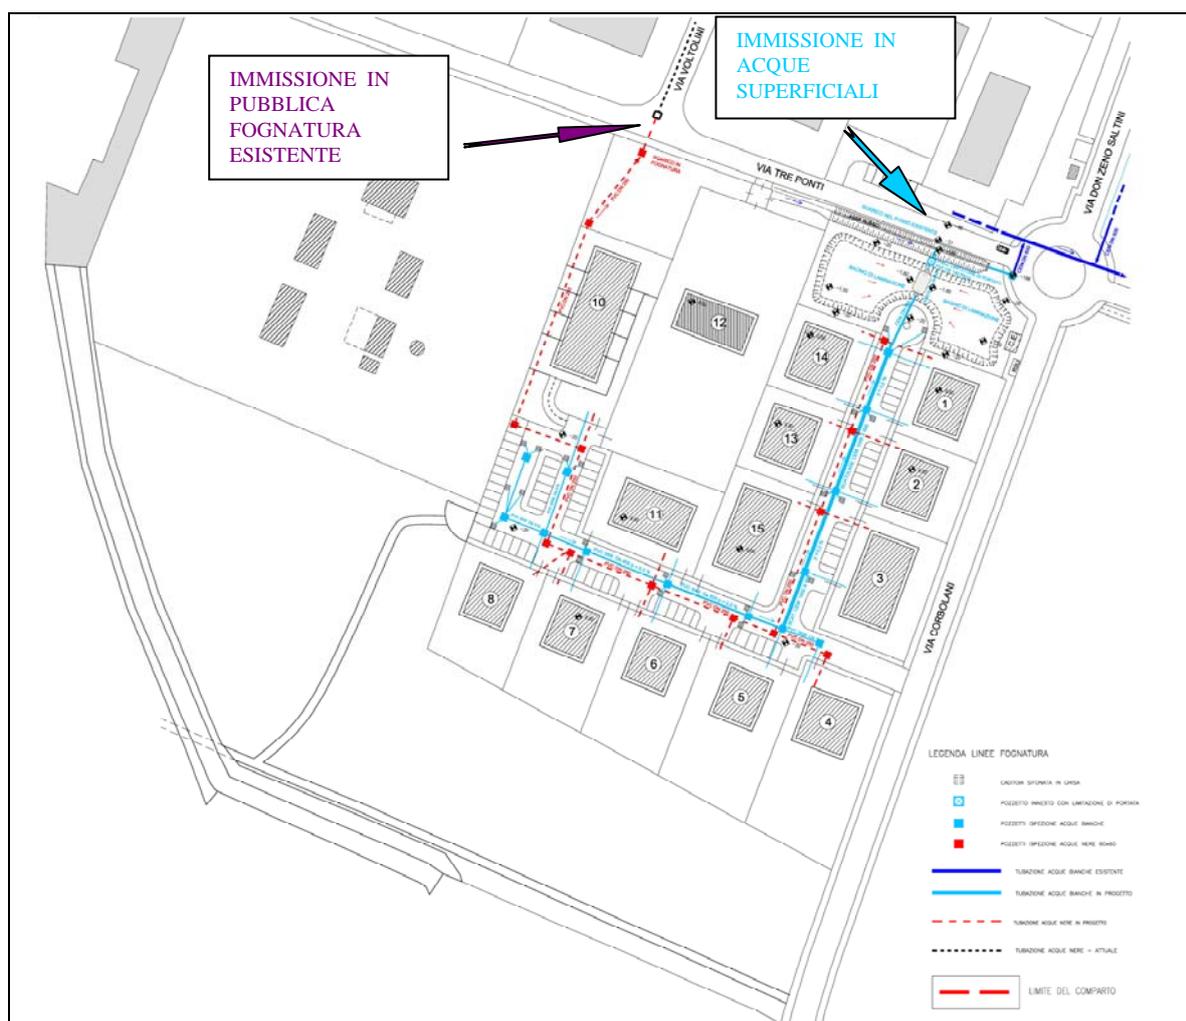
PLANIMETRIA GENERALE RETI FOGNARIE DI PROGETTO
